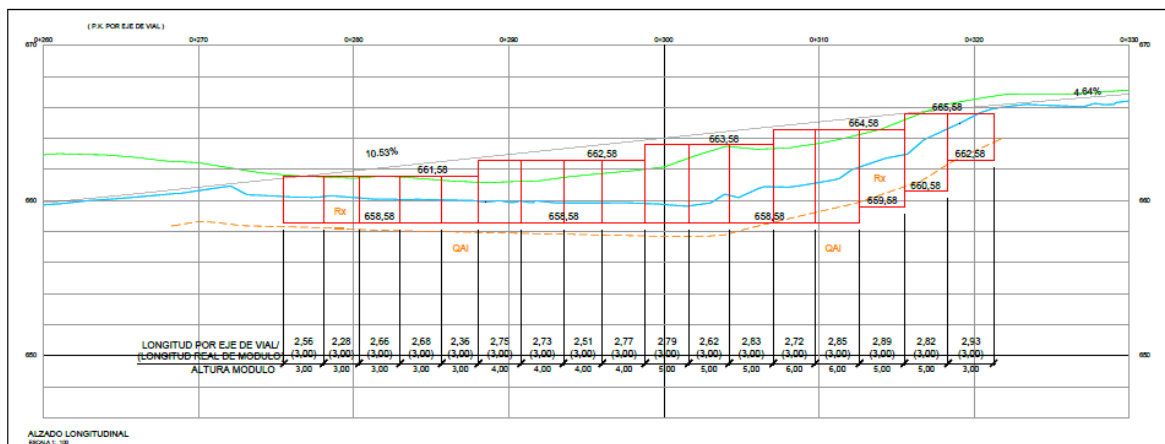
Alzado muro en gaviones San Jerónimo. Tomado de (Anexo 2 ESTABILIDAD MURO_1-S.Jeronimo-UF2.1)
